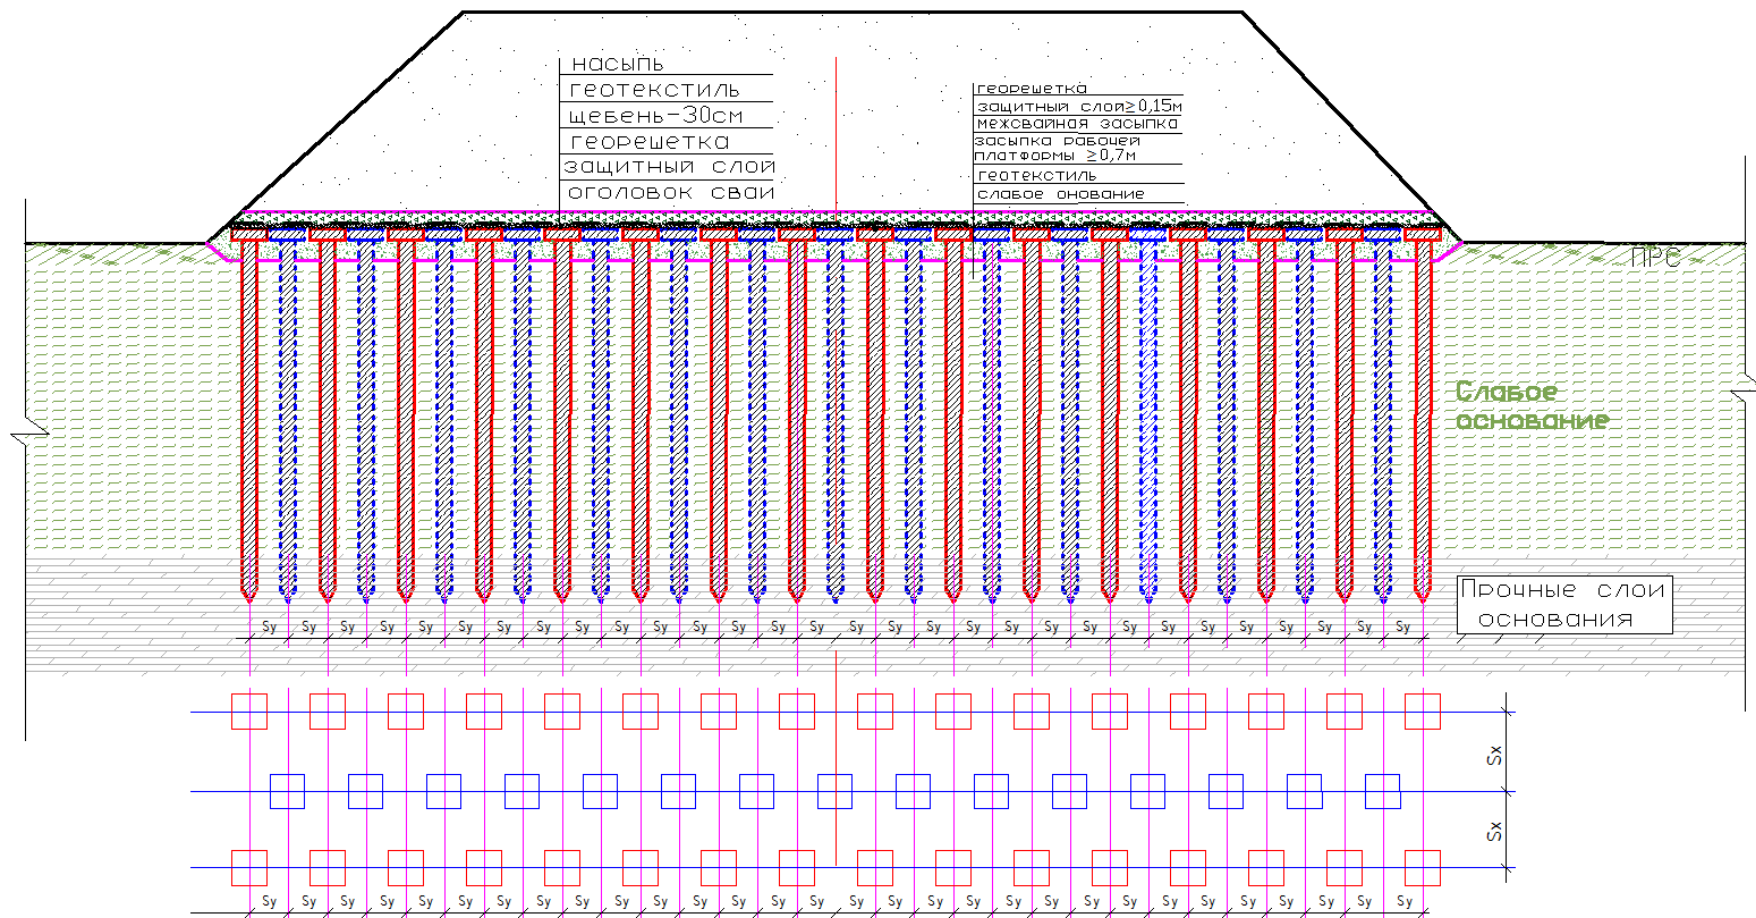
Гибкий ростверк из одного слоя георешетки со щебнем на железобетонных сваях с оголовками (с размещением свай по треугольной сетке в «шахматном порядке»)
